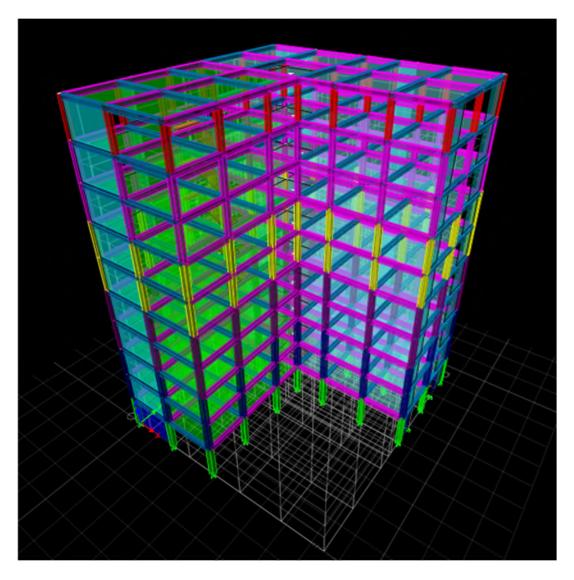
Modélisation 3D de la structure sur ETABS 2016.
